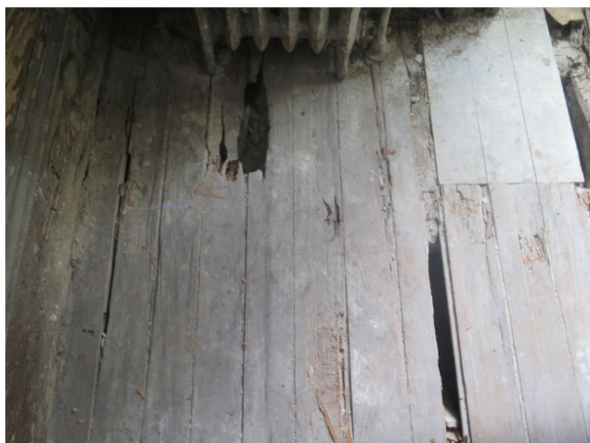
Estado da estrutura do pavimento (vista superior) (NCREP, 2017)
